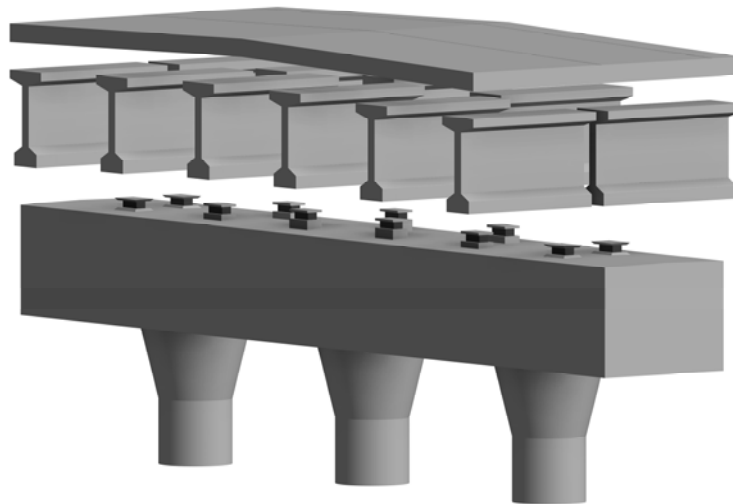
Vista desplazada de la losa, vigas, apoyos rectangulares de altura variable y pila.
